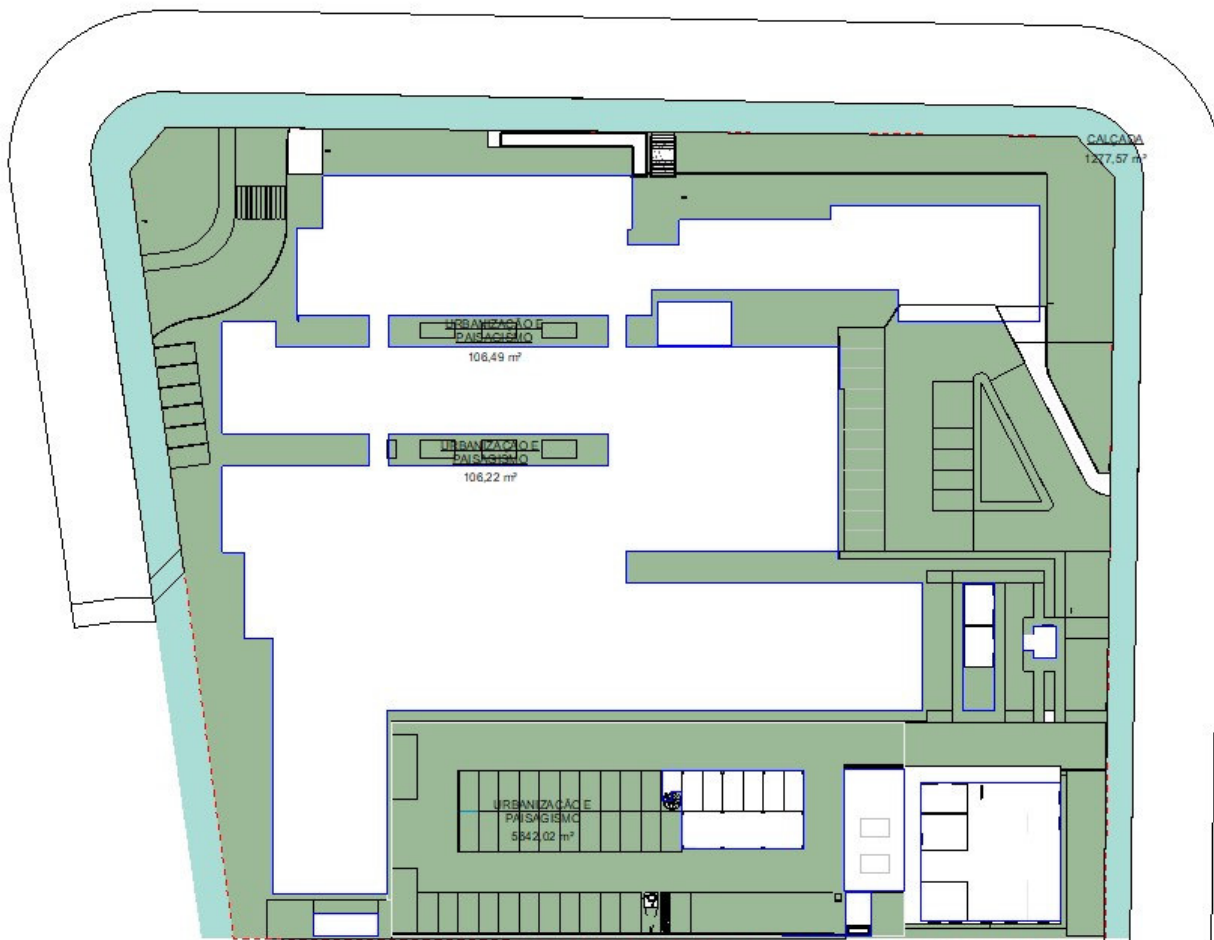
Croqui de áreas no desenvolvimento do projeto 2º Pavimento
